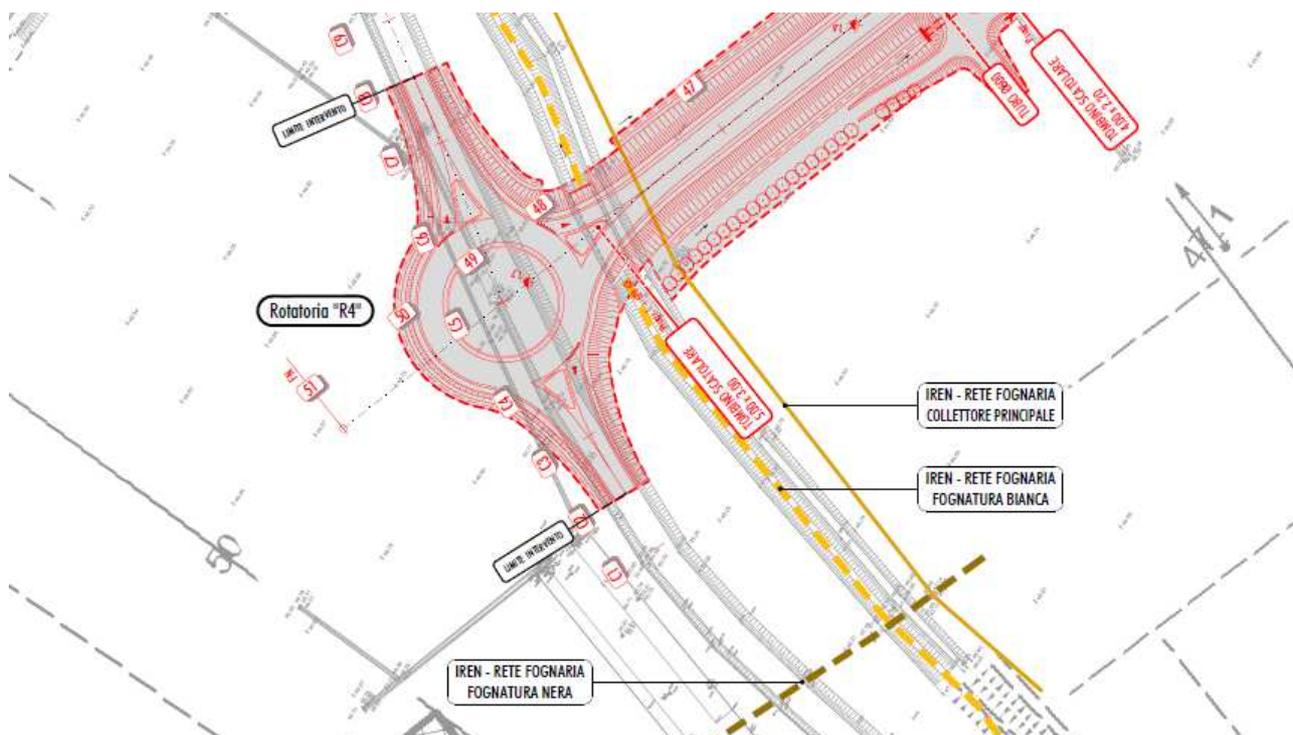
PLANIMETRIA DI RAFFRONTO CON INDICAZIONE DELLE INTERFERENZE – TAV 2/2
